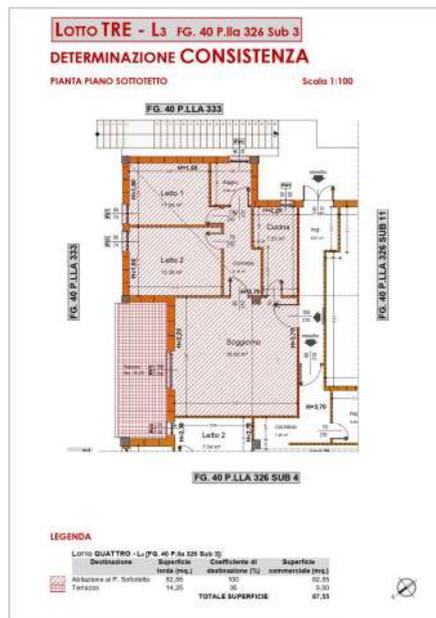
Determinazione consistenza Lotto L3 (ALL. 11).
